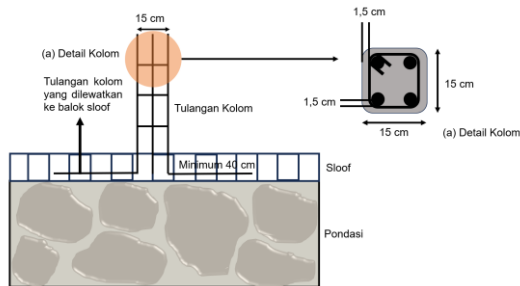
Detail Sambungan Pondasi dengan Balok Pengikat atau Sloof
